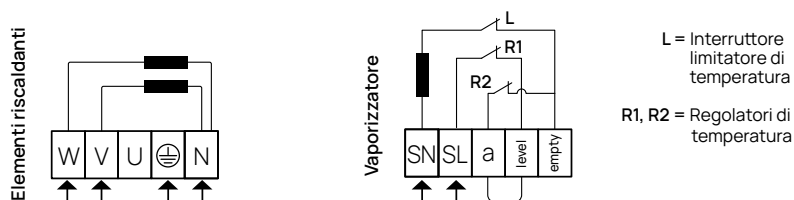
Collegamenti CORE Wall Mini e CORE Wall Mini Combi.
